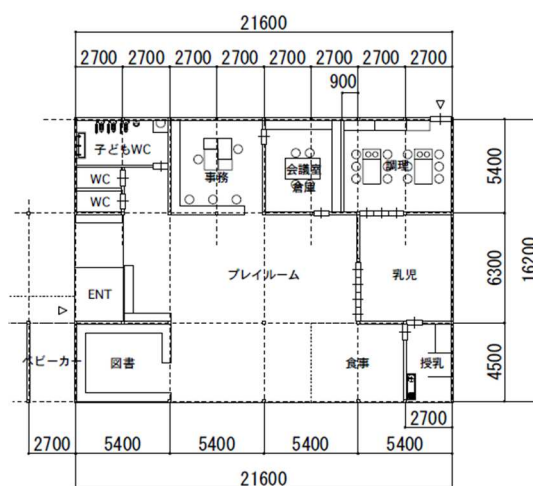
道の駅「パレットピア大野」子育てはうす「ぱすてる」平面図
